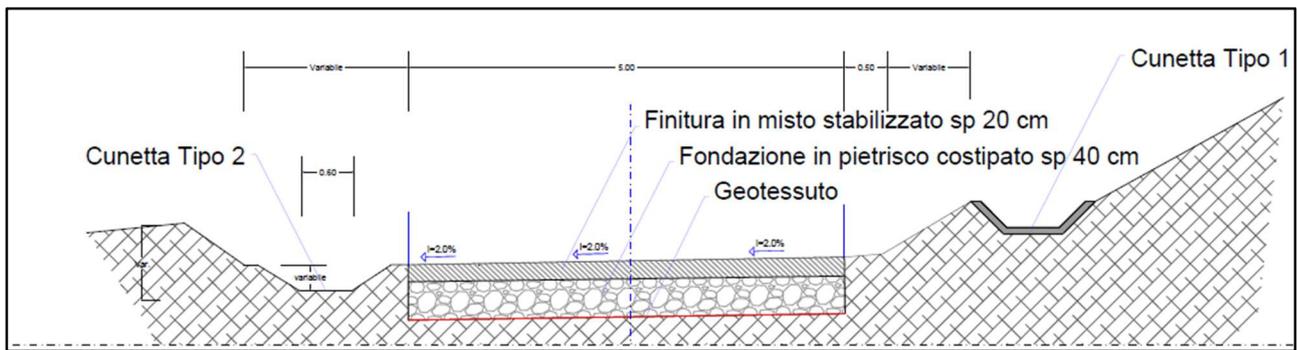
Sezione tipo viabilità con drenaggio a monte e a valle
